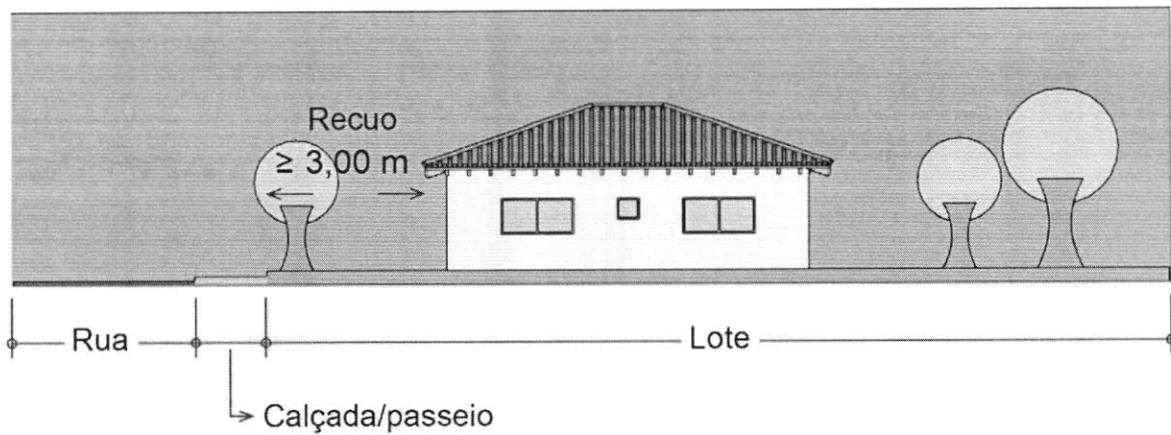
Recuo Frontal sem projeção do pavimento Térreo
